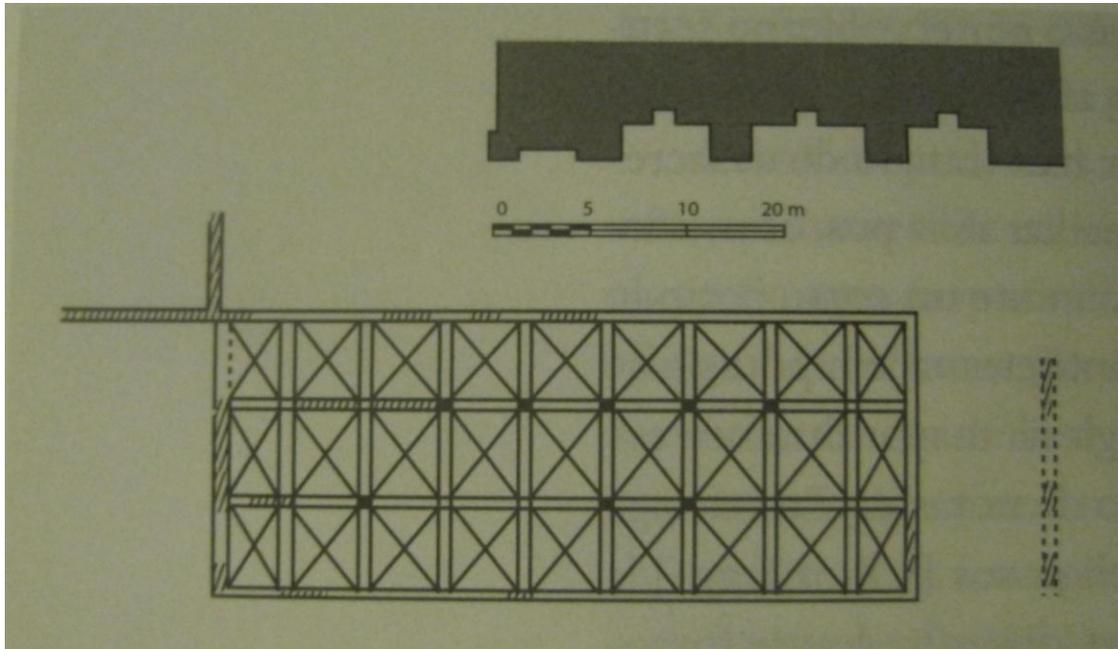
Planta de la primera catedral elaborada por Toussaint, *Arquitectura mexicana del siglo XVI...*, 362.
